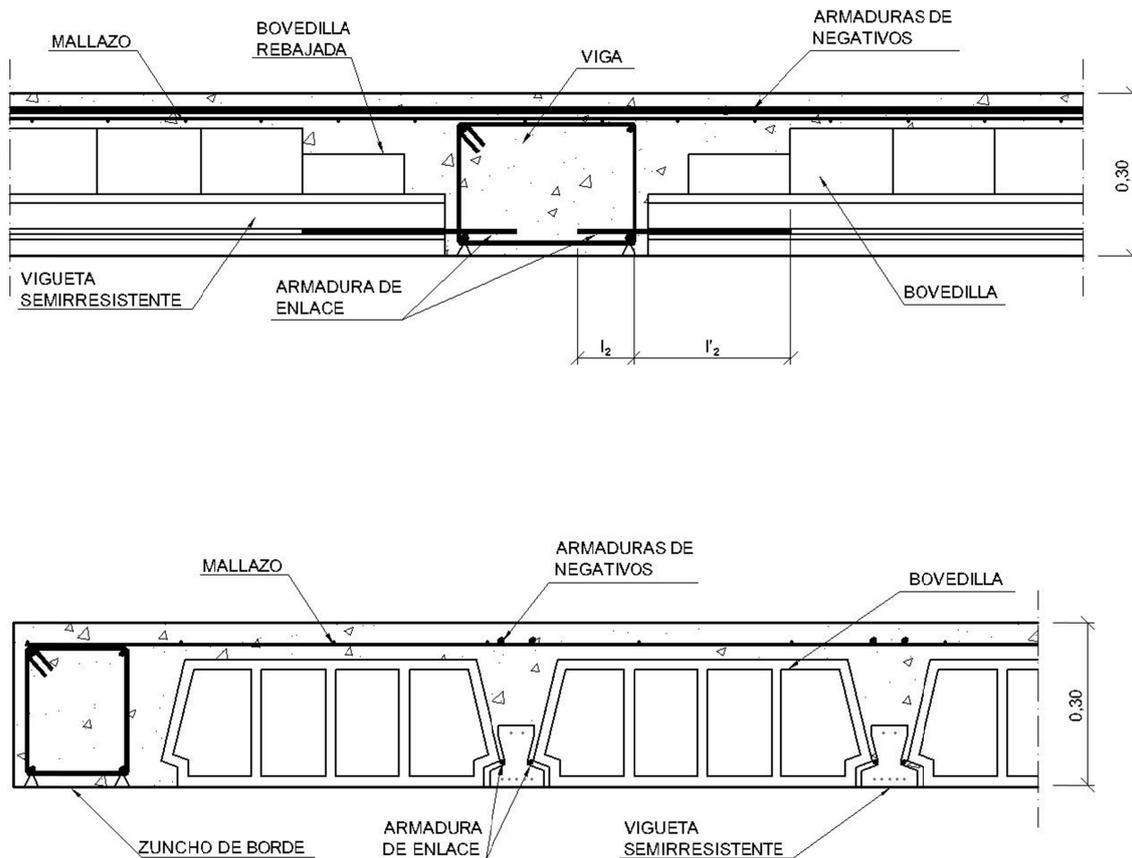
Detalle apoyo doble sobre viga - Enlace por solapo
